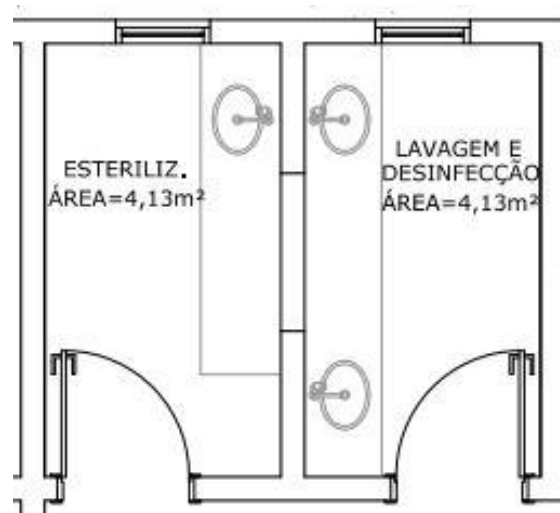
Área de Esterilização/ Lavagem e Desinfecção
